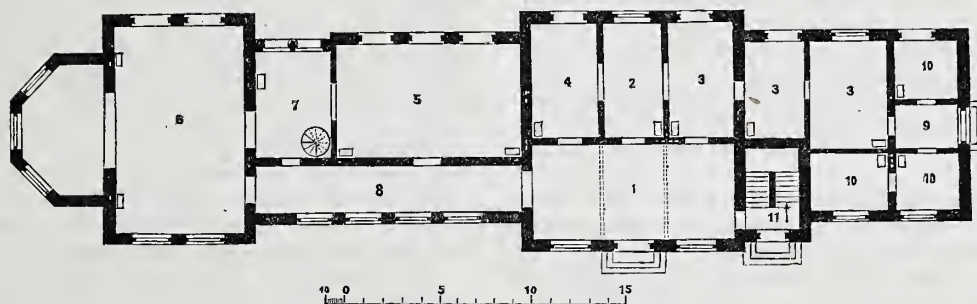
Grundriss vom Erdgeschoss.
